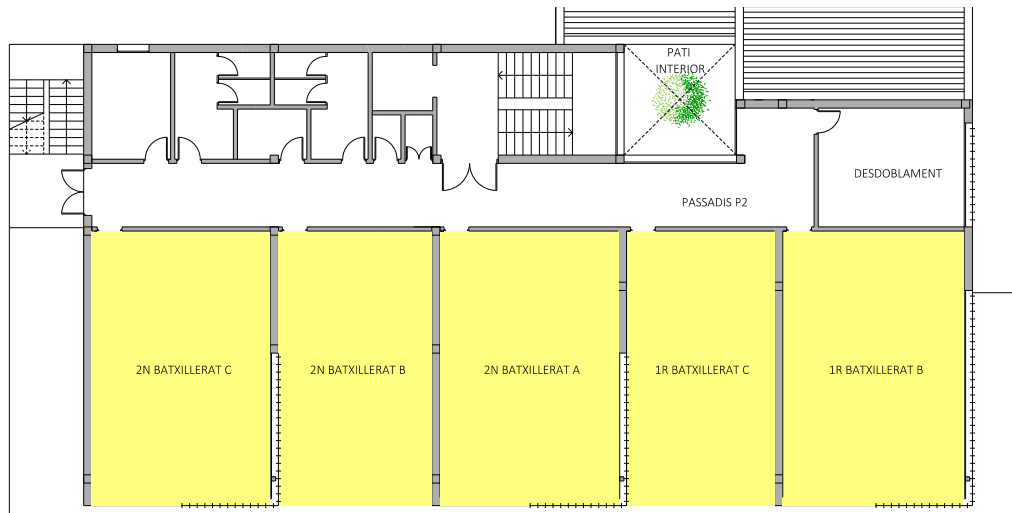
Proposta 3, Edifici D, Planta Segona. Font: Elaboració pròpia.
